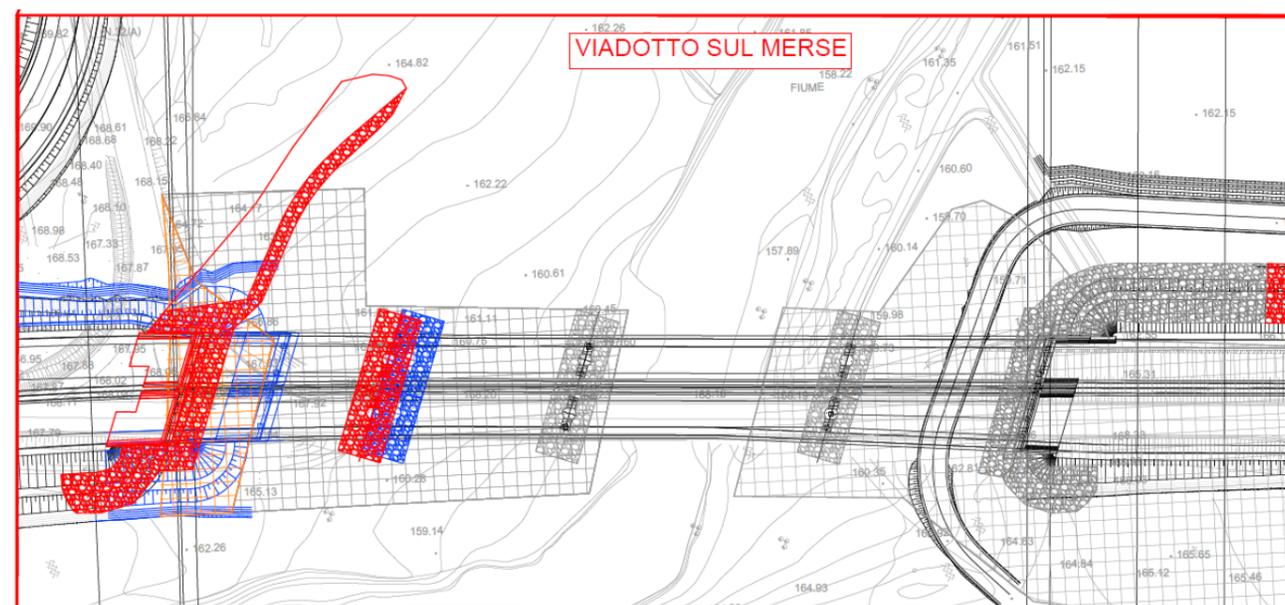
Planimetria di sovrapposizione tra PE_VA e PE_169, del tratto in corrispondenza del Viadotto Merse
